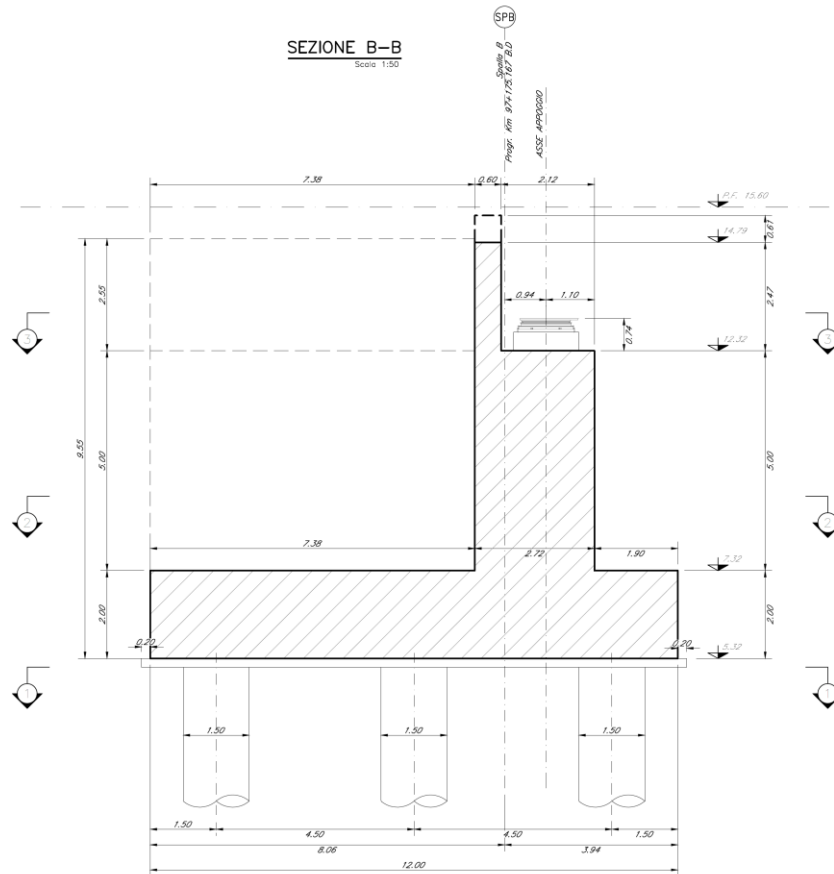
Sezione longitudinale della spalla B – Lato Ventimiglia.
